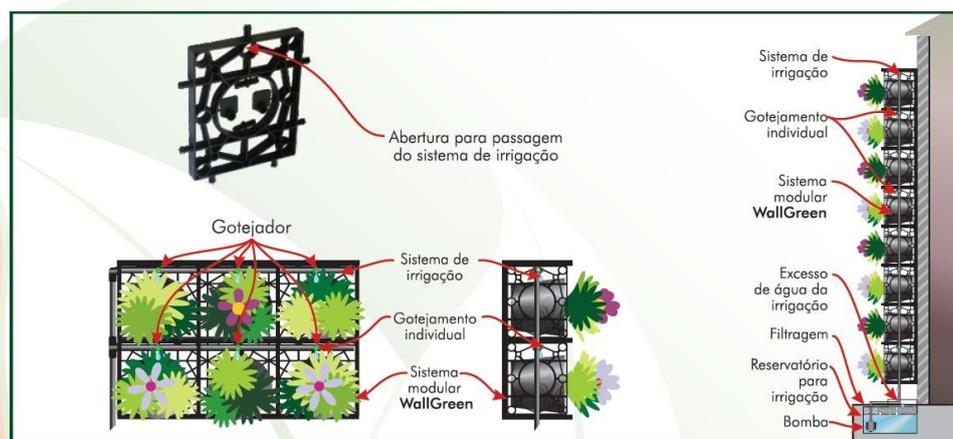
Conceito usado nos sistemas pré-fabricados da empresa brasileira Wallgreen
